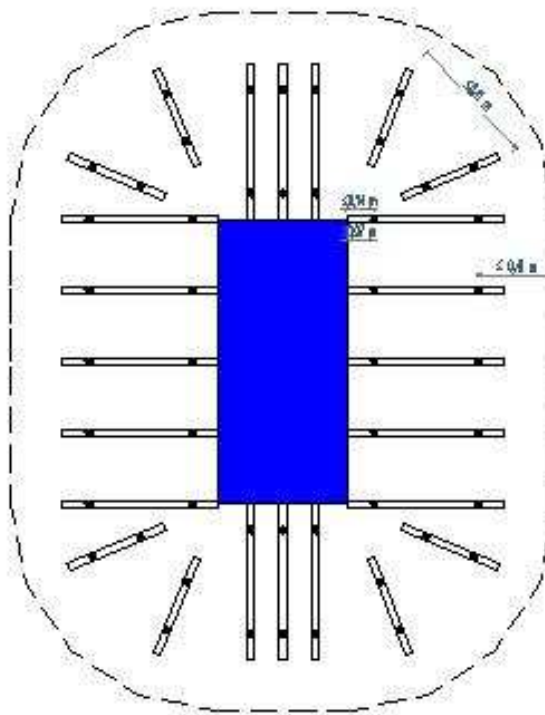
Disposição de armadura de punçoamento em planta.
